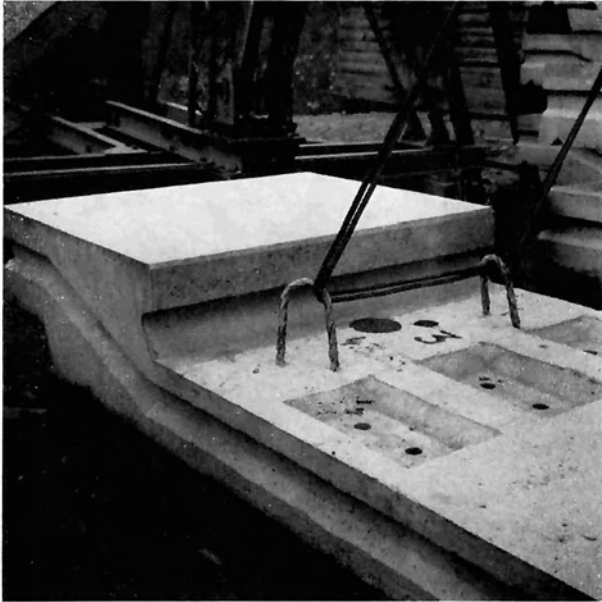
Die Detailaufnahme zeigt die saubere Ausführung der Stahlbetonplatten mit den Aussparungen in der Oberseite für die Druckplatten der HV-Schrauben und die Ausführung der Preßfuge mit der Ausnehmung zur besseren schiefesten Verbindung. – Die Bezeichnung der Platte (Nr. 3) und das Datum der Herstellung (4. März 1963) sind neben der Aussparung für die Entwässerung erkennbar
